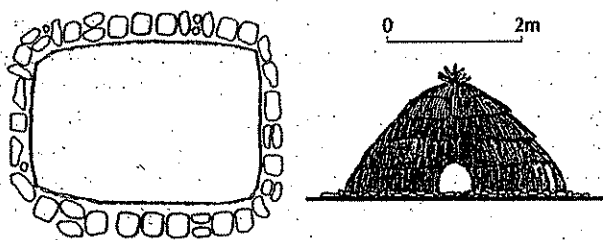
Planta de una casa rectangular y reconstrucción hipotética de la superestructura (dibujo basado en Cristino, Vargas e Izaurieta, 1983).
